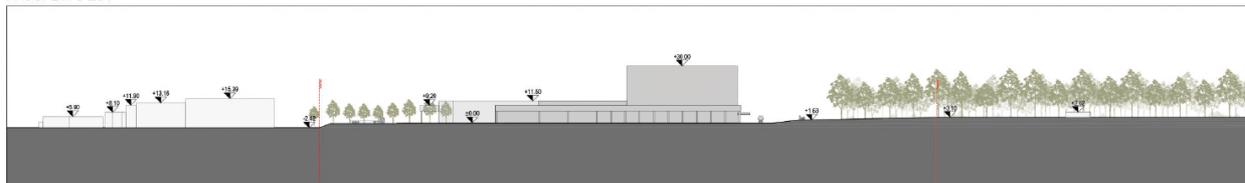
Stralcio Tav. n 06 Sezioni e prospetti progetto
